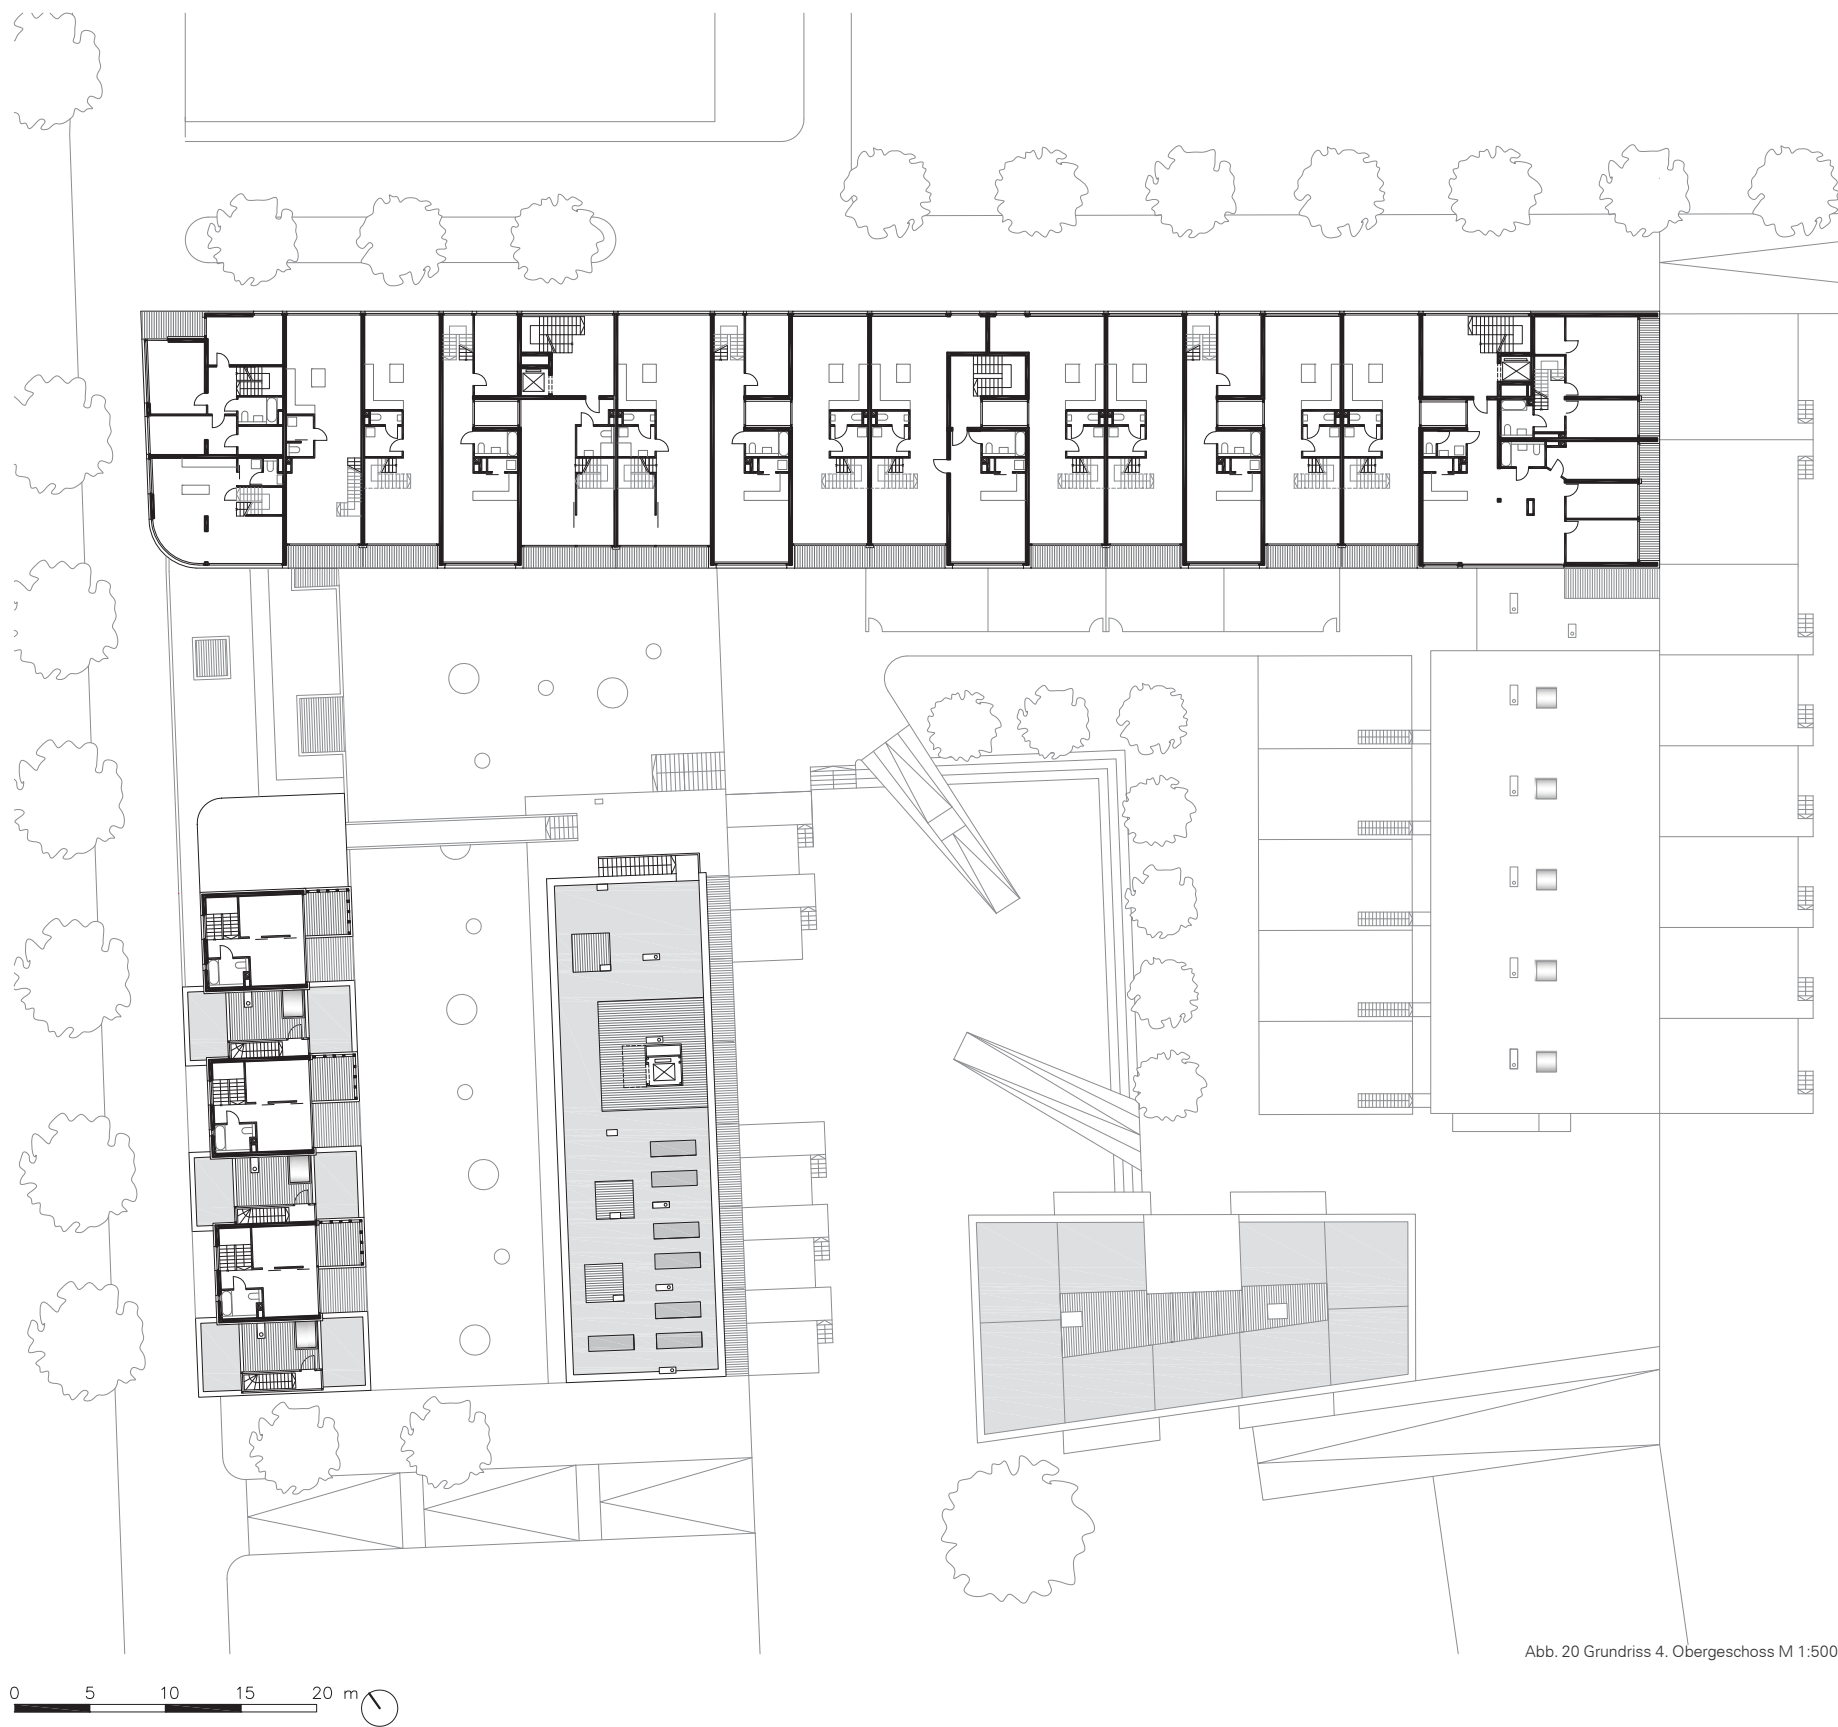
Grundriss 4. Obergeschoss M 1:500
